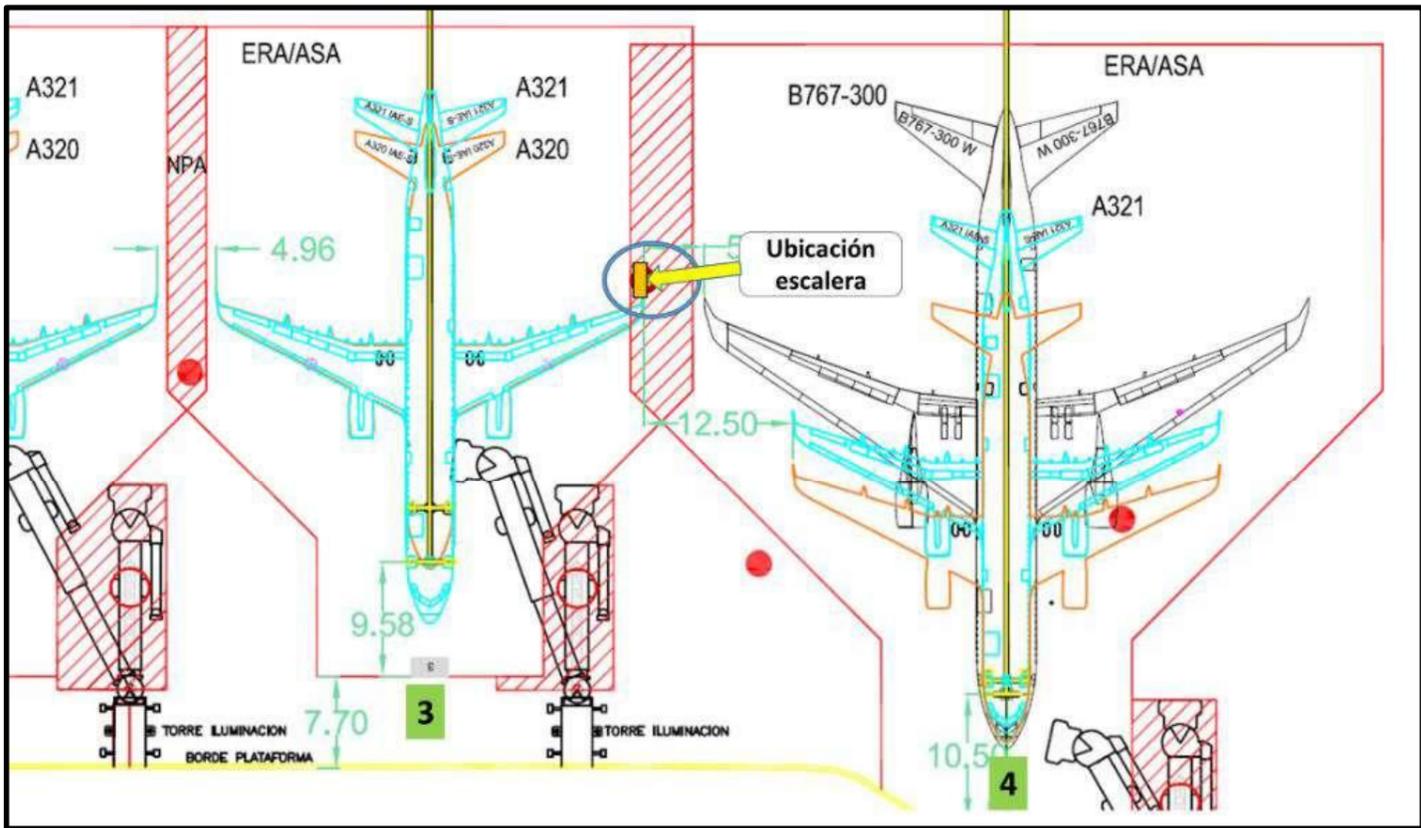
Ubicación de la escalera en un Área de Prohibición de Estacionamiento (NPA) y área de solape de estacionamientos N° 3 y 4 (Flecha amarilla).
